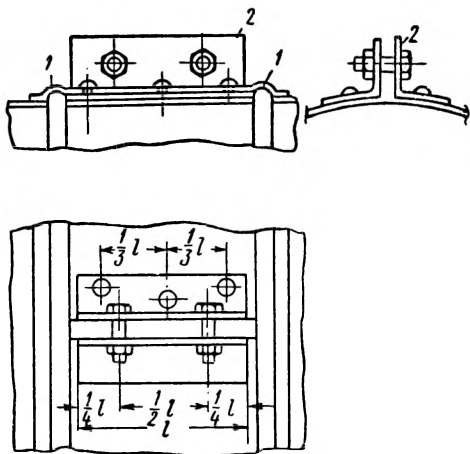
Соединение звеньев воздухопроводов круглого сечения
